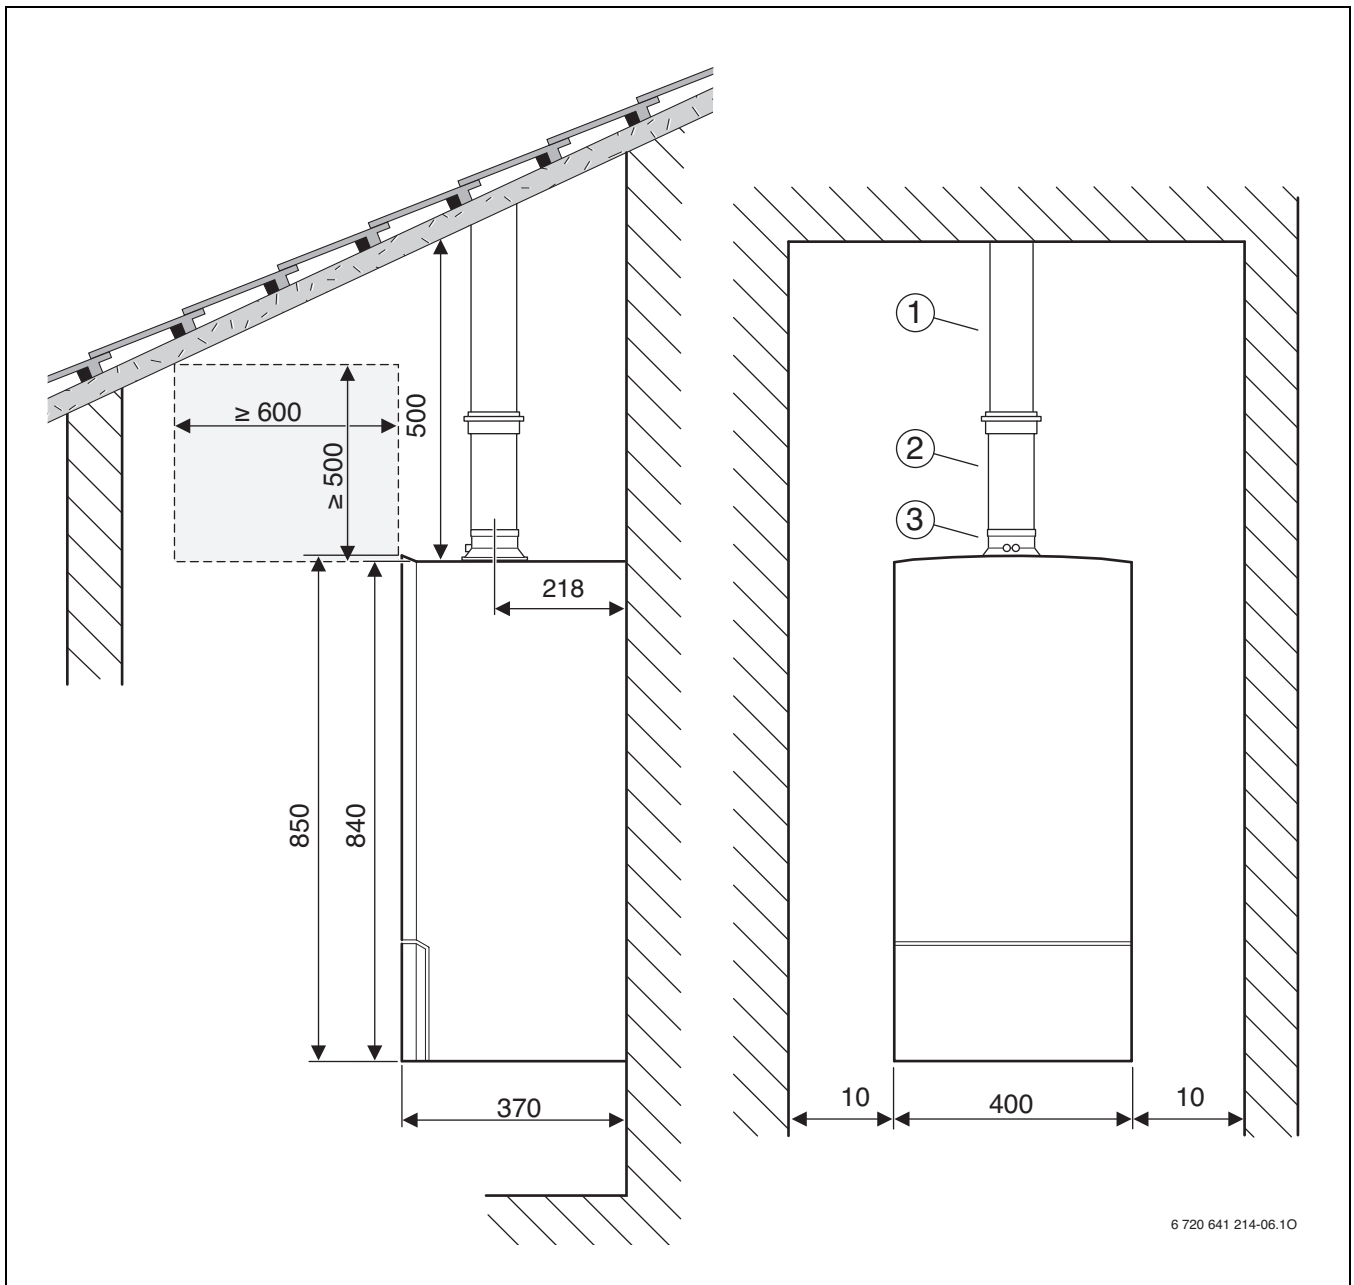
$\varnothing$  60/100 mm eller  $\varnothing$  80/125 mm, skråtag
